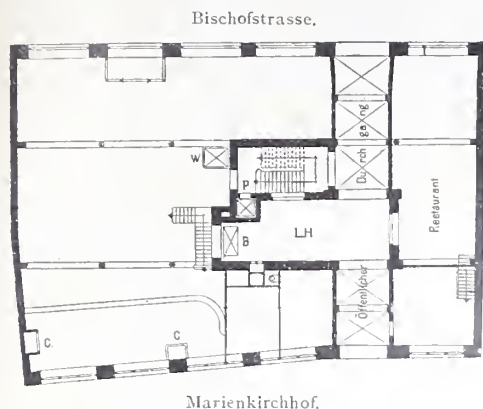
Erdgeschoss-Grundriss 1:500.
